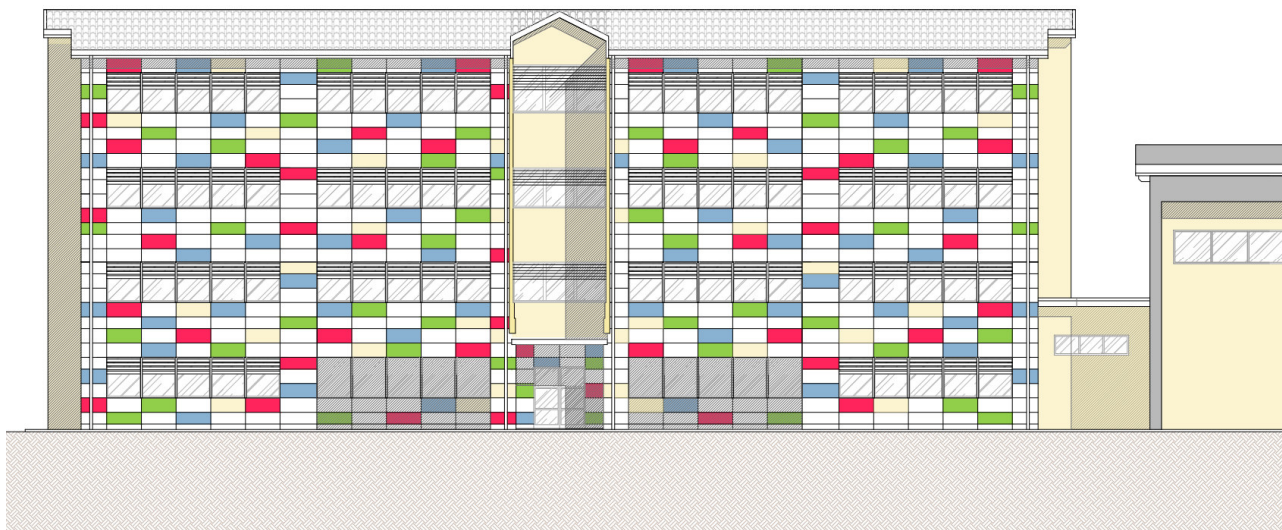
Stralcio Prospetto Sud con facciata ventilata
